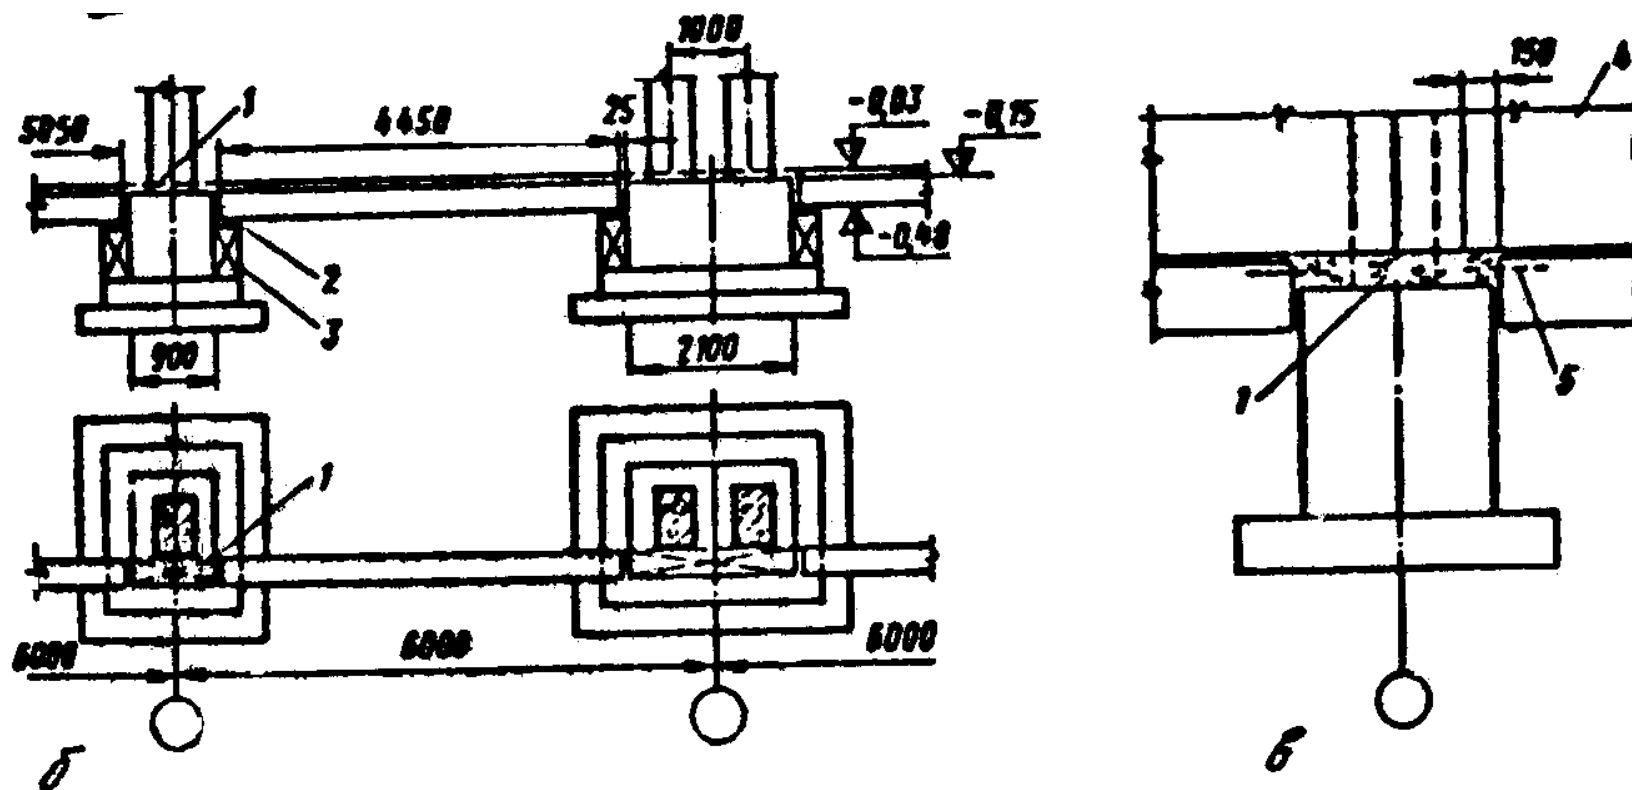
(б, в.) – Схема фундаменту балок:
